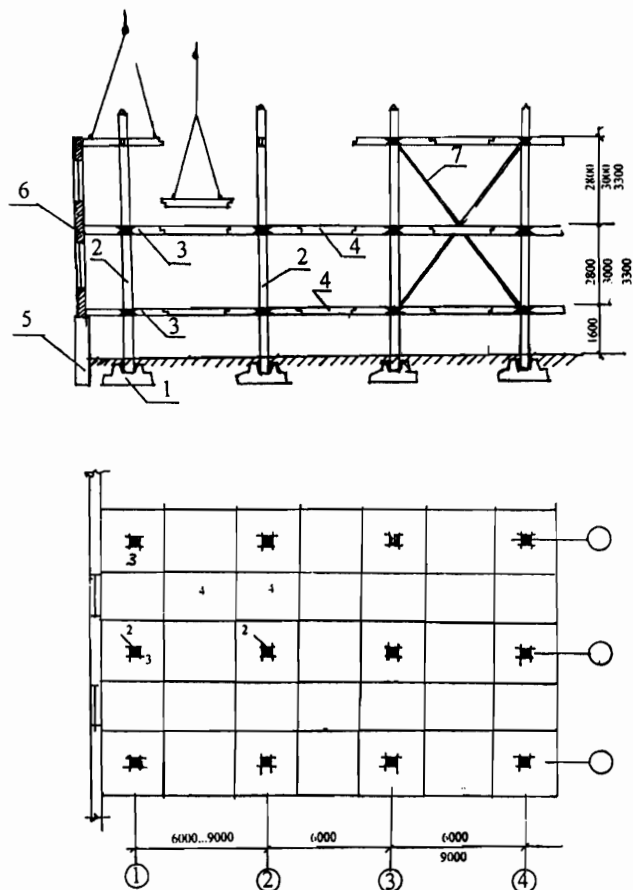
Конструктивно-технологическая схема системы «КУБ»: 1 – фундаменты под колонной стаканного типа; 2 – многоярусные колонны; 3 – 4 – наклонные плиты; 5 – фундамент под наружные стены; 6 – стеновое ограждение в виде панелей на 2 этажа; 7 – связи
